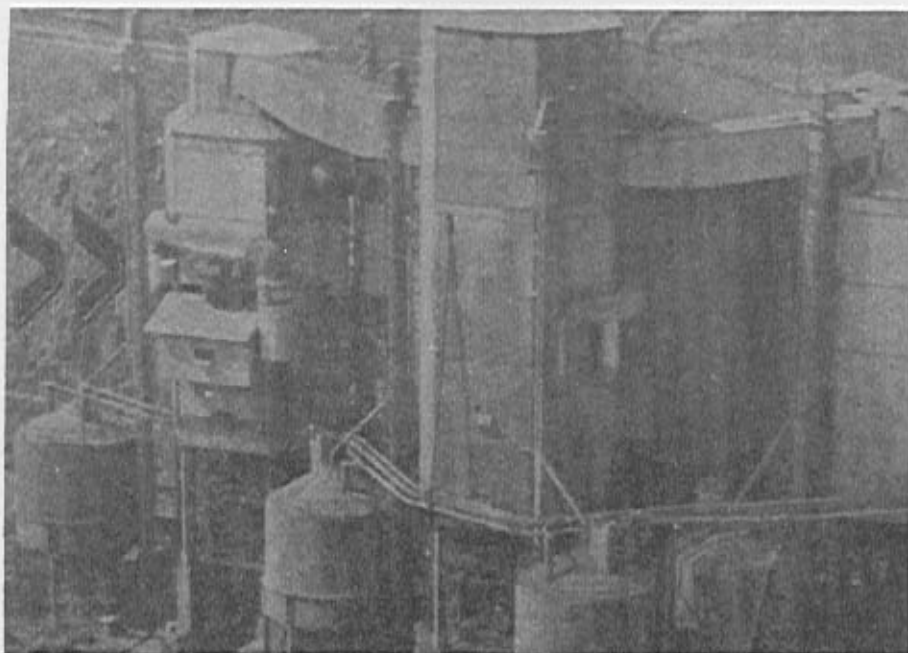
Sistema Adotado em Itaipu, para a Insuflação do Ar Frio.
